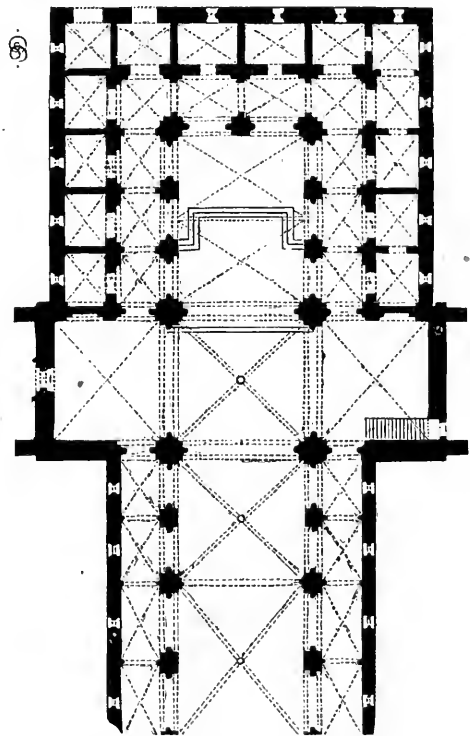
Kirche zu Kiddagshausen. Grundriss.
